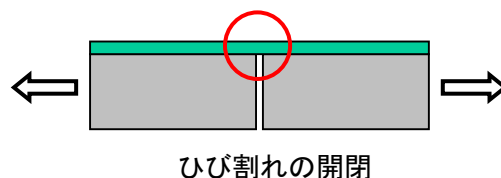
表面被覆材のひび割れ追従性のイメージ
